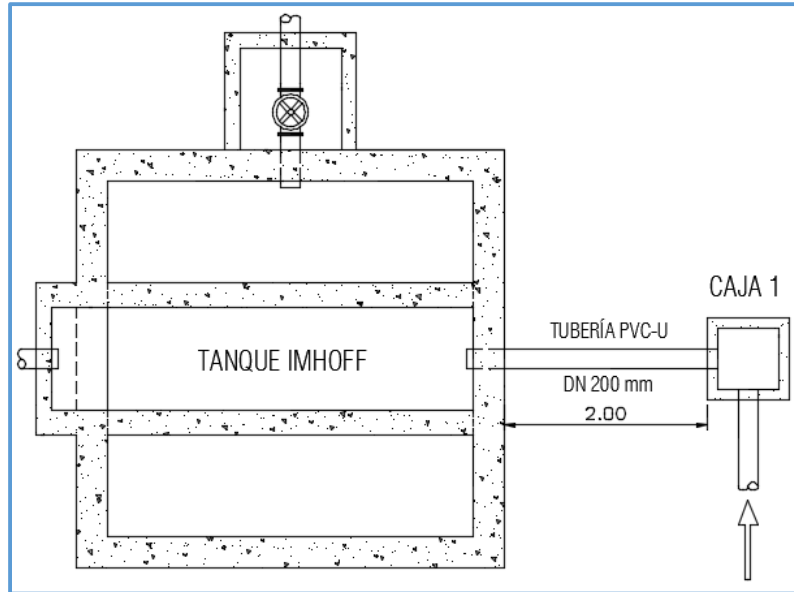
Vista en planta del tanque Imhoff y tubería PVC DN 200 mm
